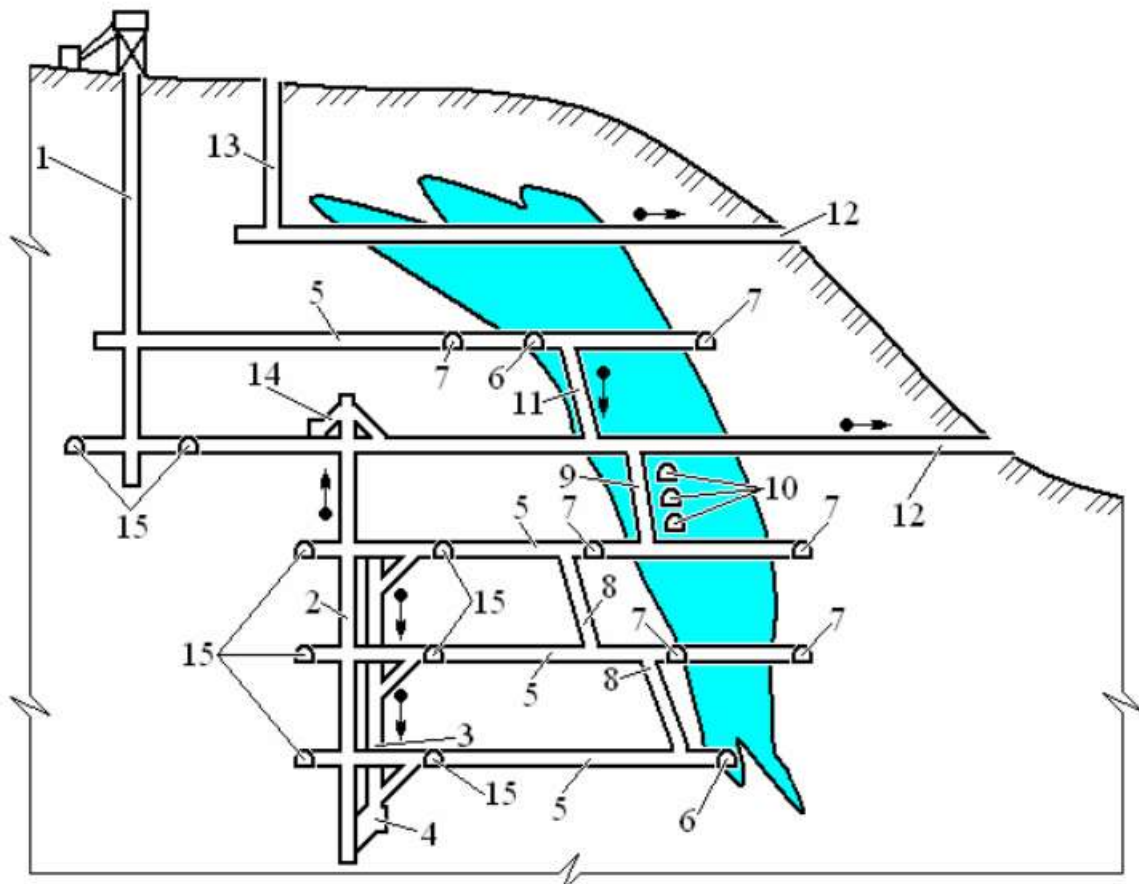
Схема расположения подземных горных выработок при разработке рудной залежи (разрез вкрест простирания)
